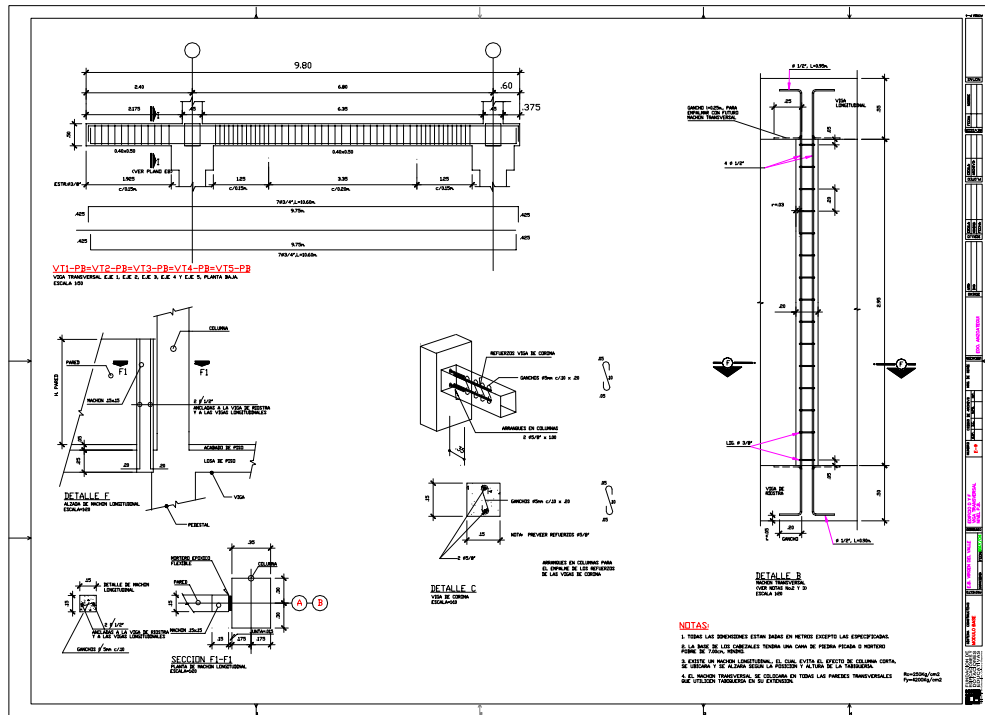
Edificio D y F. Viga transversal. Nivel P.B. Modulo de Base.
